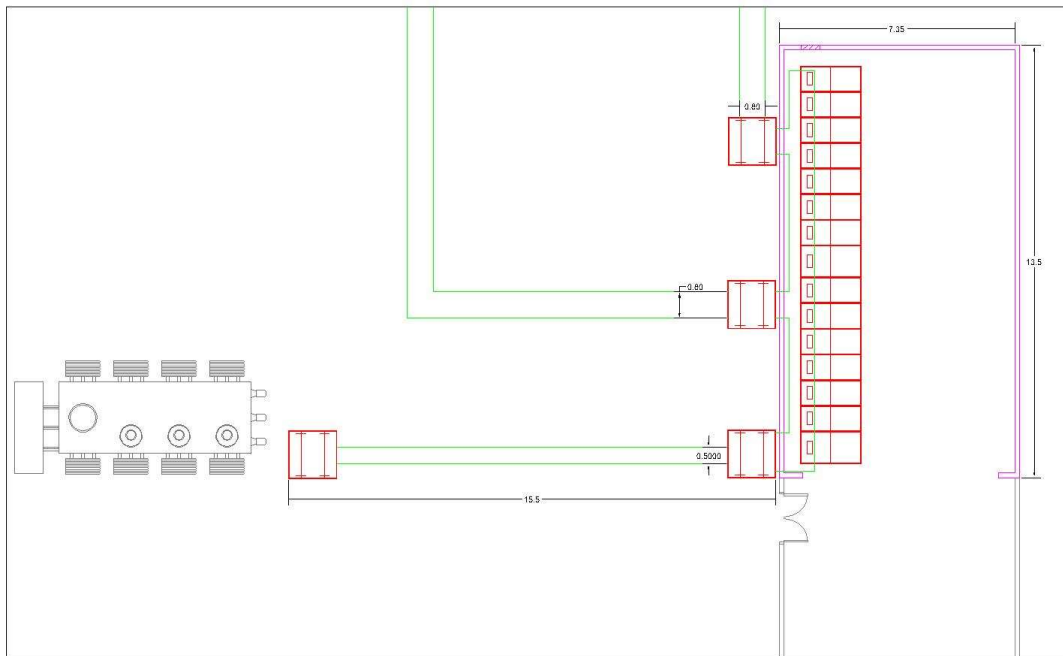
Plano de construcciones a realizar para la instalación de celdas
